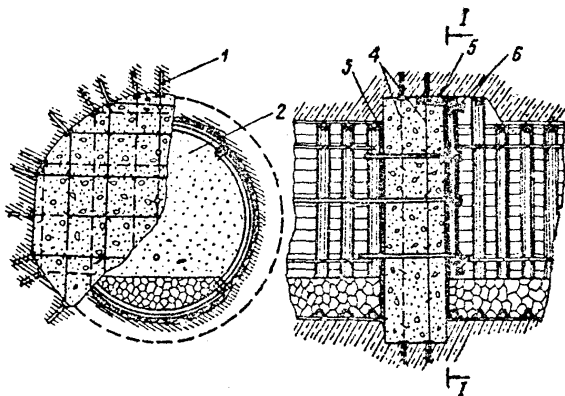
Железобетонная динамически устойчивая перемычка:
